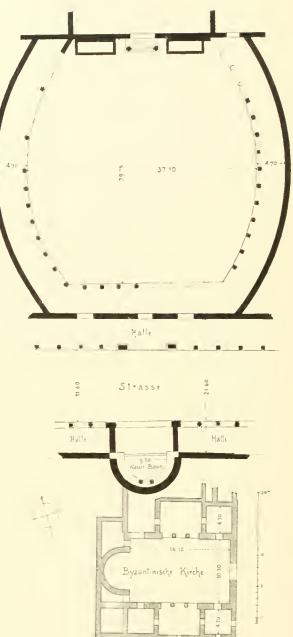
Grundriss der Arkadiane bei der Straßenkreuzung.
